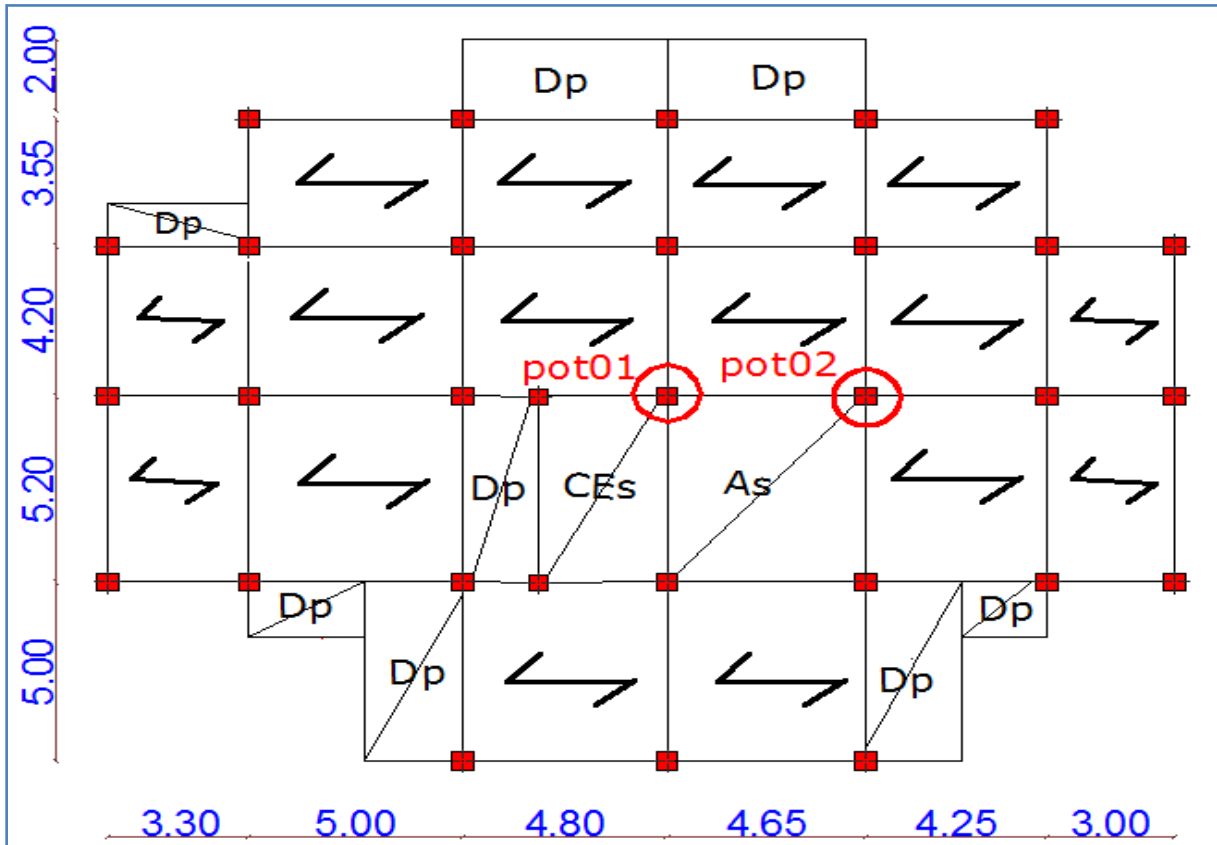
Plan de disposition des poutrelles (étage 06 et 07)
